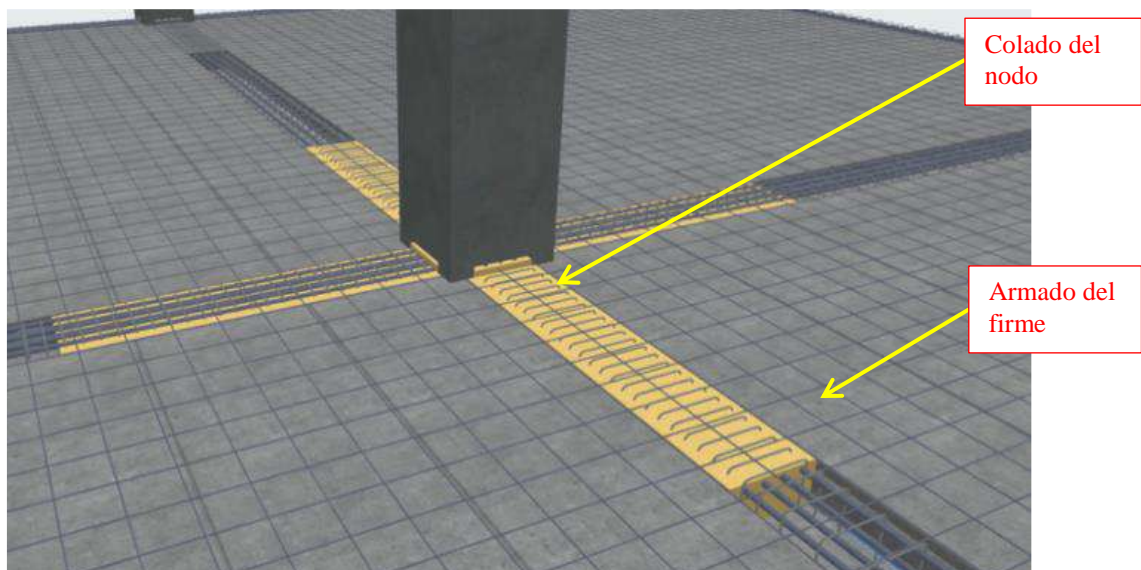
Nodo de una columna interior. Armado del firme de concreto.
